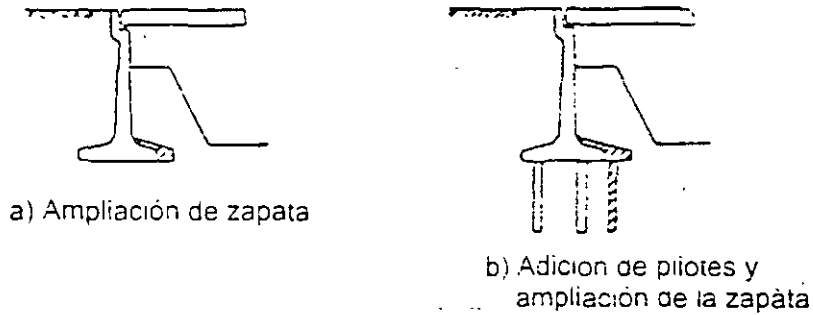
REFORZAMIENTO SISMICO PARA CIMENTACIONES DE ESTRIBOS
